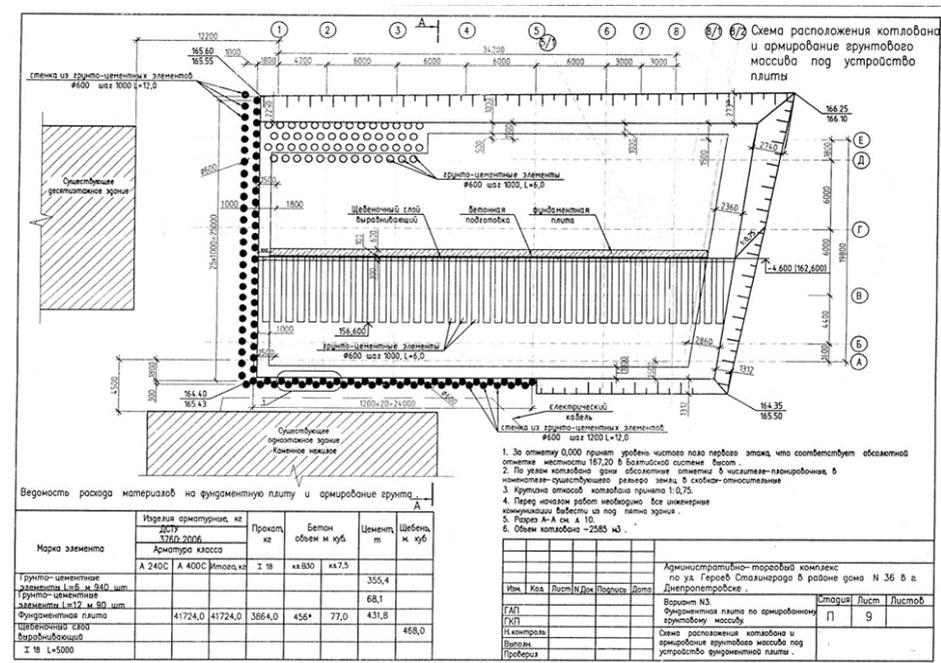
Схема выполнения работ по закреплению бортов котлована и усилению грунтов основания плитного фундамента
